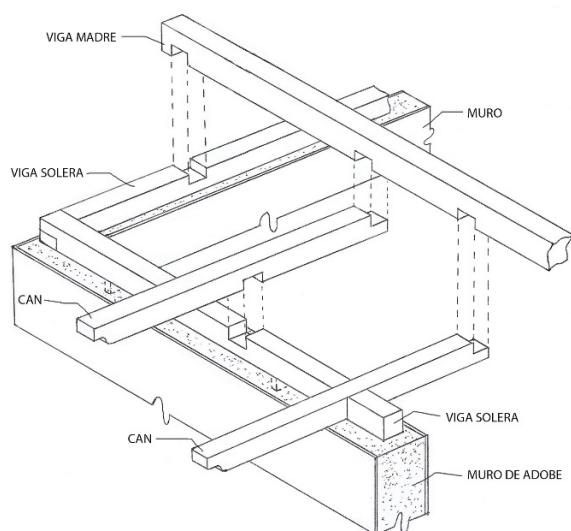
Detalle de los canes que crean el apoyo de la plataforma en voladizo. Se apoyan en el muro y en la primera viga principal de la habitación contigua (Dibujo de los autores).
